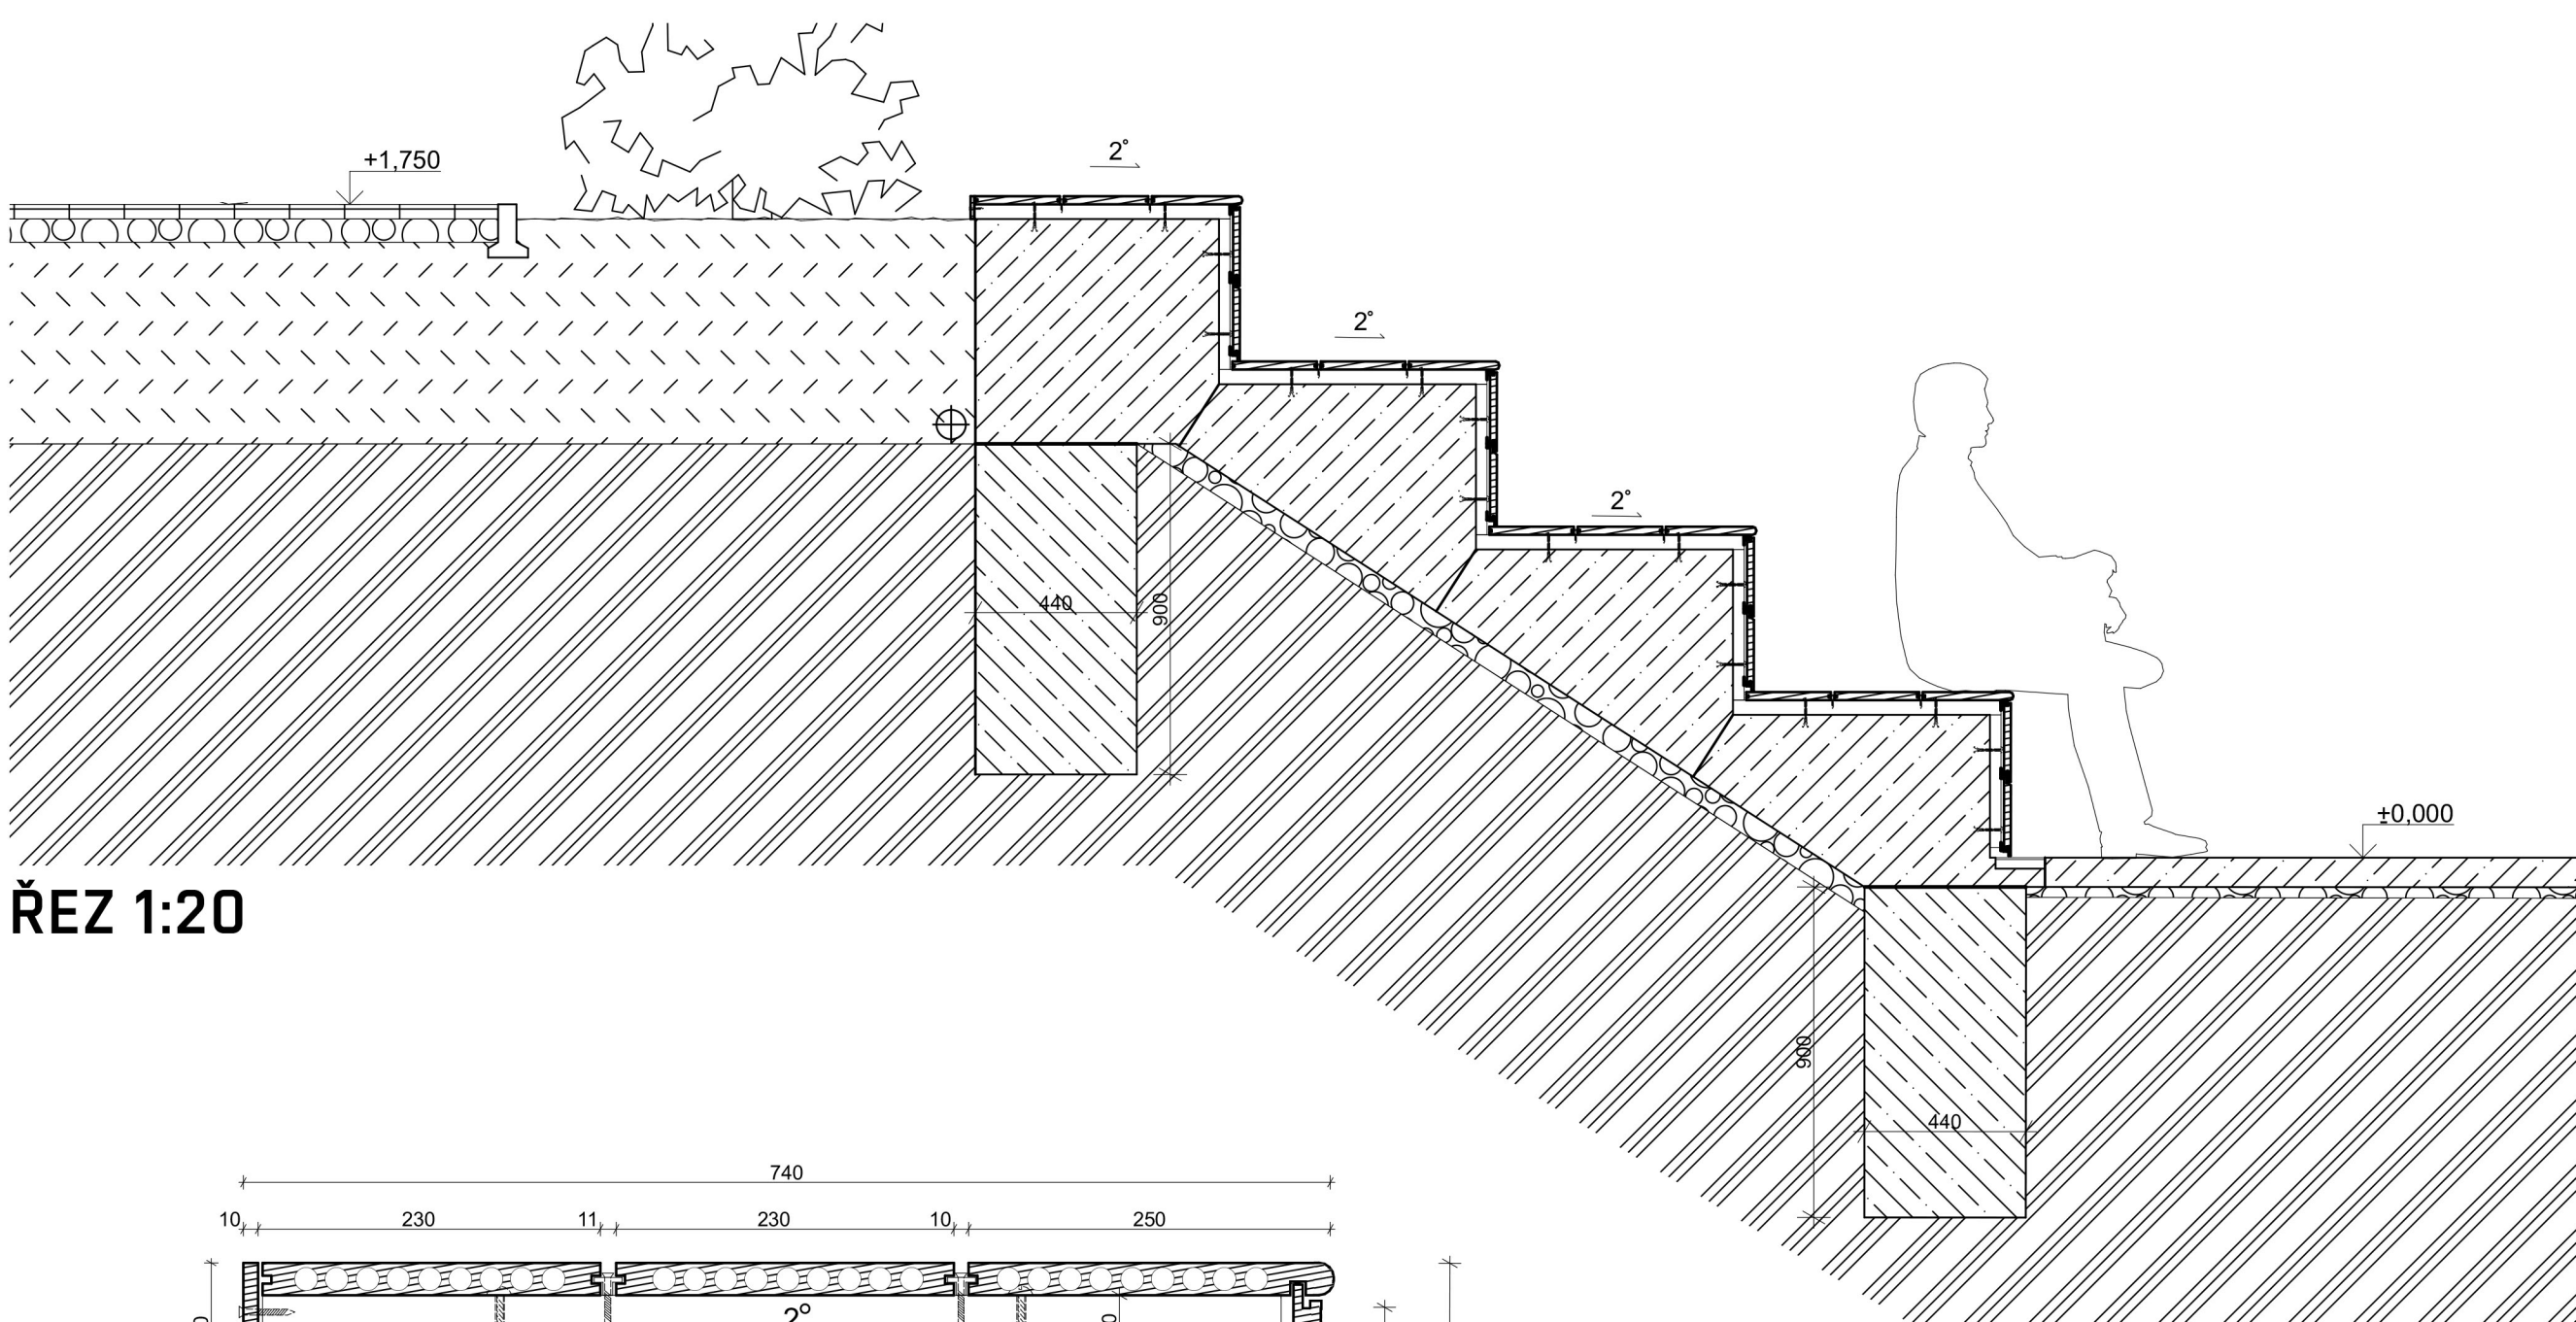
DETAIL KONSTRUKCE SCHODIŠŤOVÉHO POSEZENÍ
